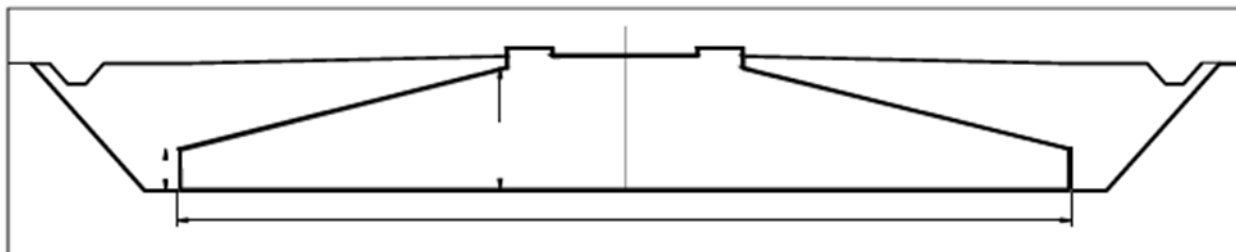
Tipico sezione fondazione Aerogeneratore
